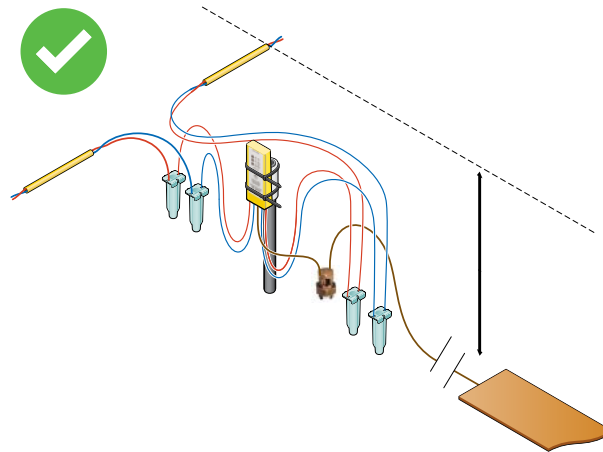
Collegamento di un modulo di protezione dai picchi di tensione Pilot-SG all'interno del percorso del cavo
